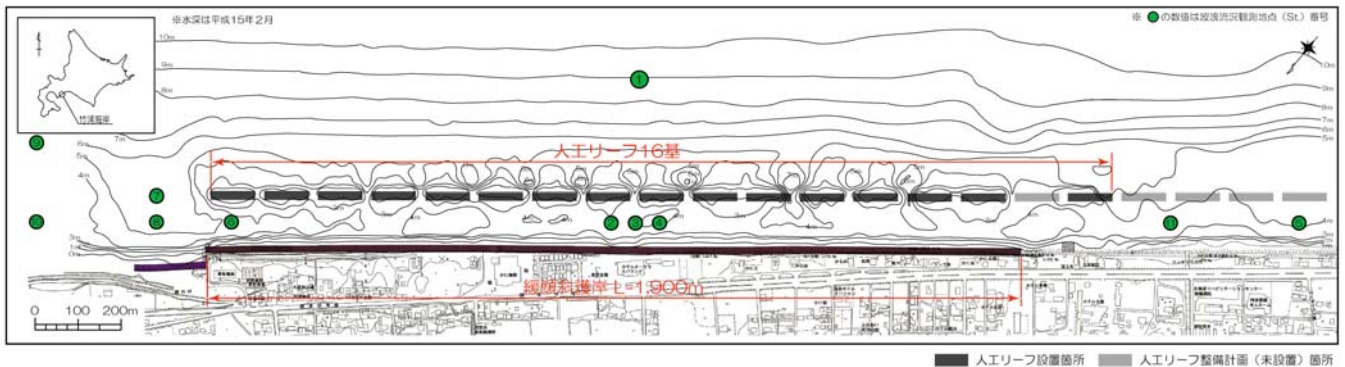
竹浦海岸施設平面図および平成15年度現地調査位置図
